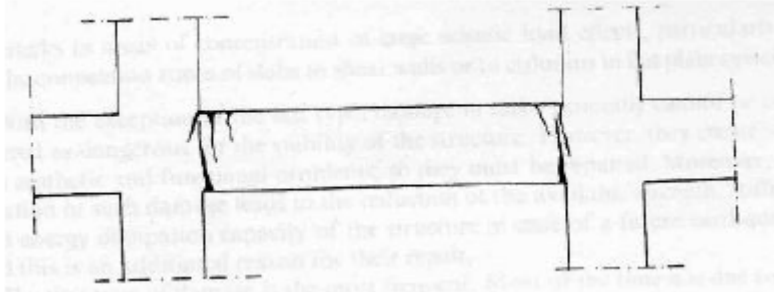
Fissures de Flexion sur les faces supérieure ou inférieure aux appuis de la poutre.
